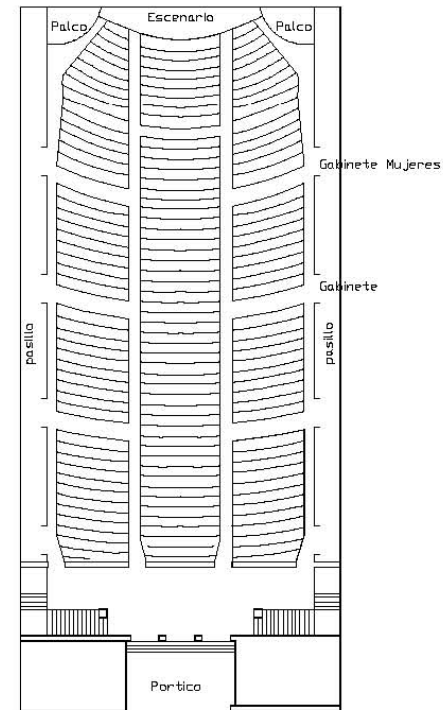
Plantas esquemáticas del cine Odeón con un pórtico muy bien definido. (AHDF).
